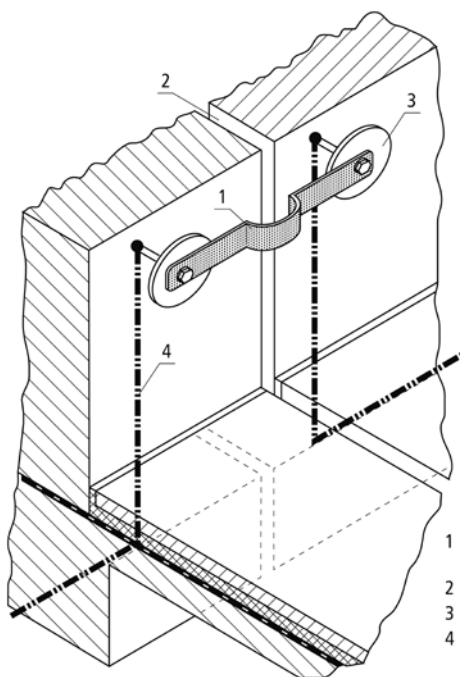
Ausführung eines Fundamenterders in unbewehrtem Fundament
